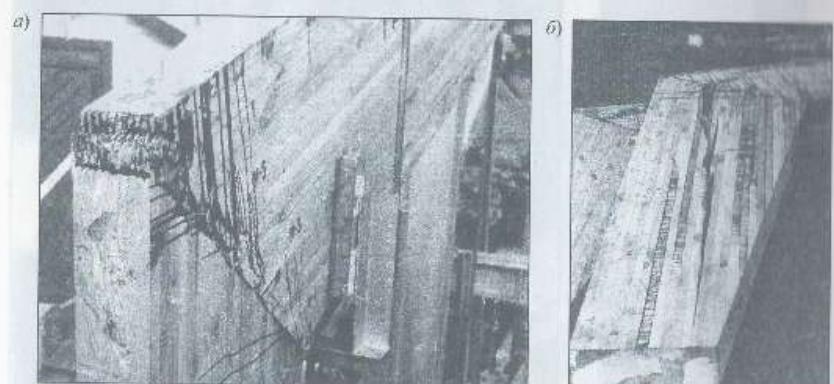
Характер разрушения рам РДП в растянутой зоне карнизного узла: а – разрыв зубчато-шипового соединения и возникновение трещин; б – магистральная трещина в стойке
